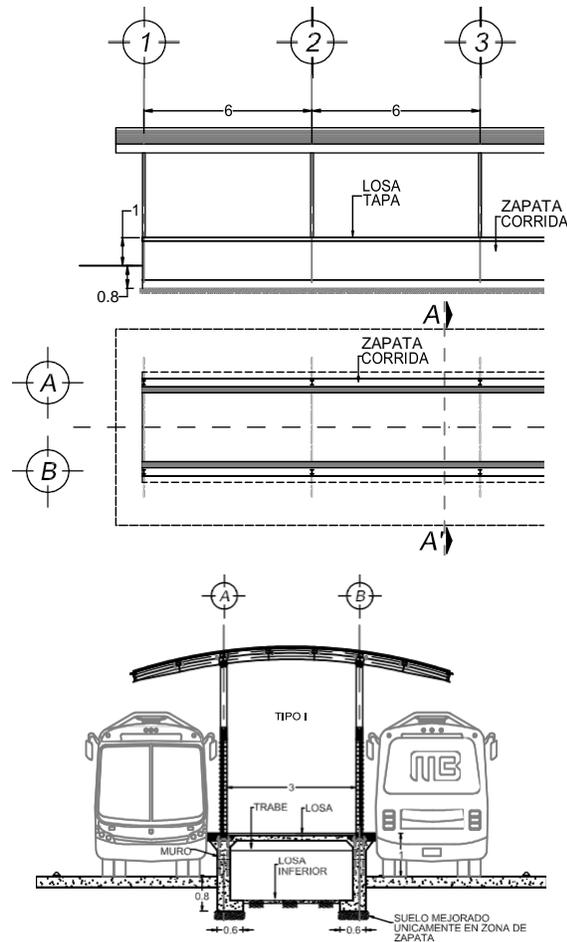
Planta y cortes longitudinal y transversal de la estación
